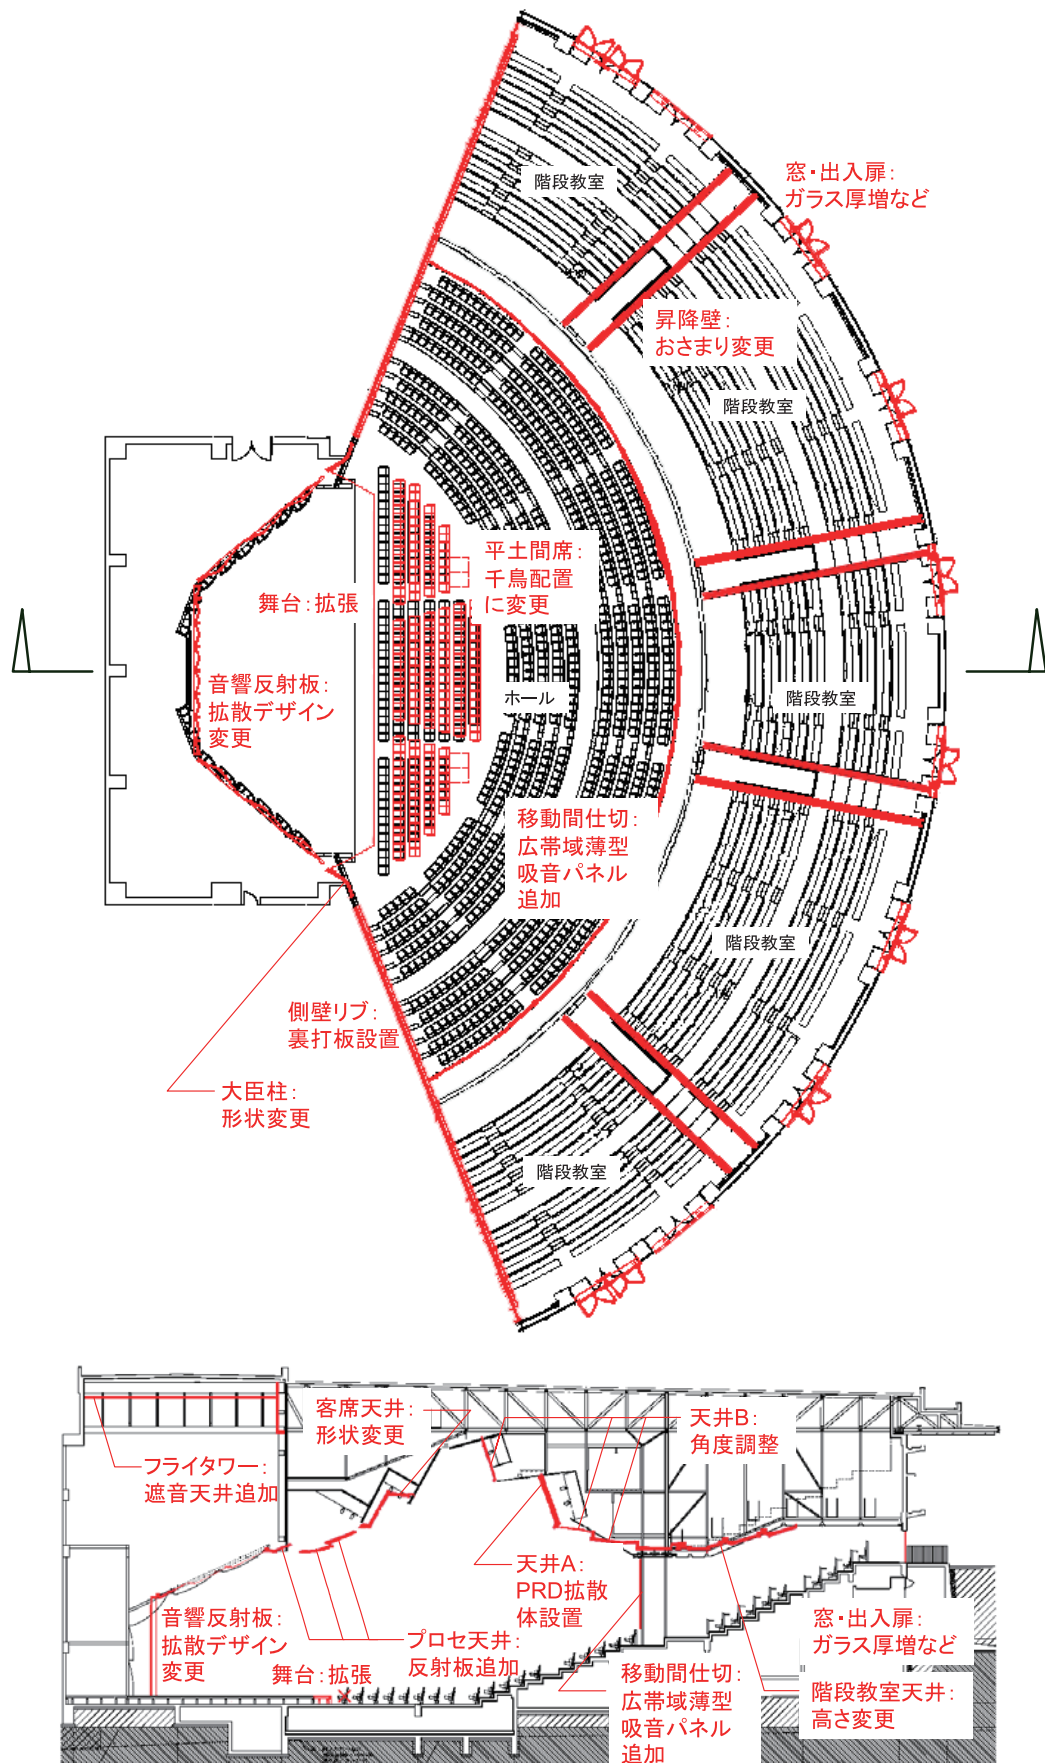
講堂の基本形状 (上: 平面図, 下: 断面図)。赤字は主な変更部位を示す
